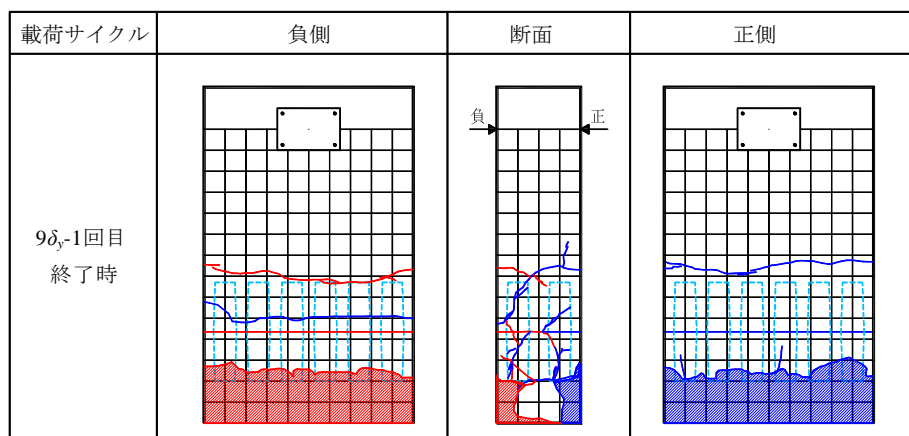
JD25A 試験体ひび割れ図 (9 δ_y)
